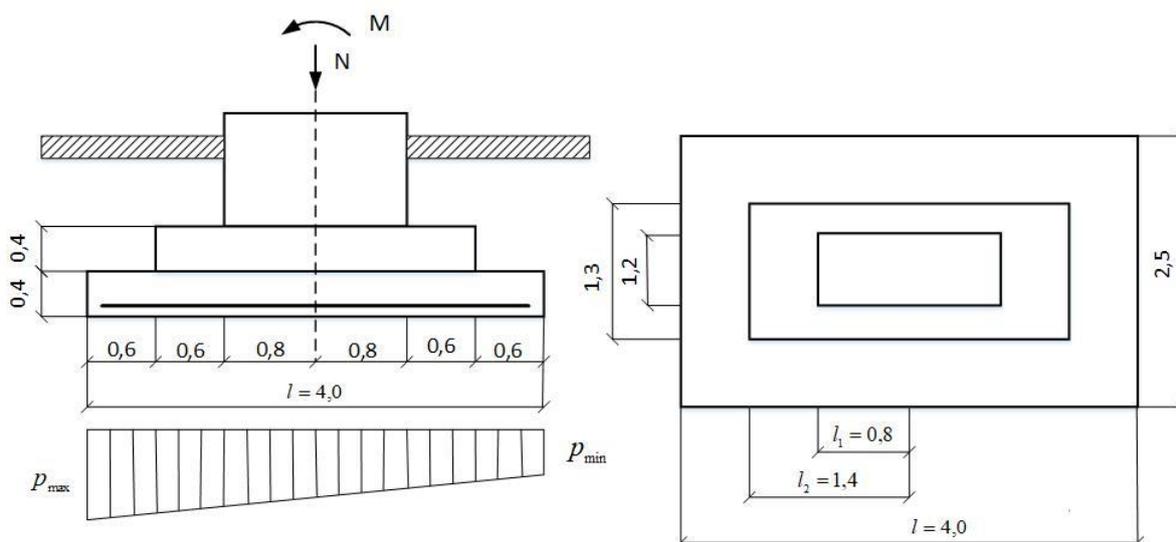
Расчетная схема столбчатого фундамента
